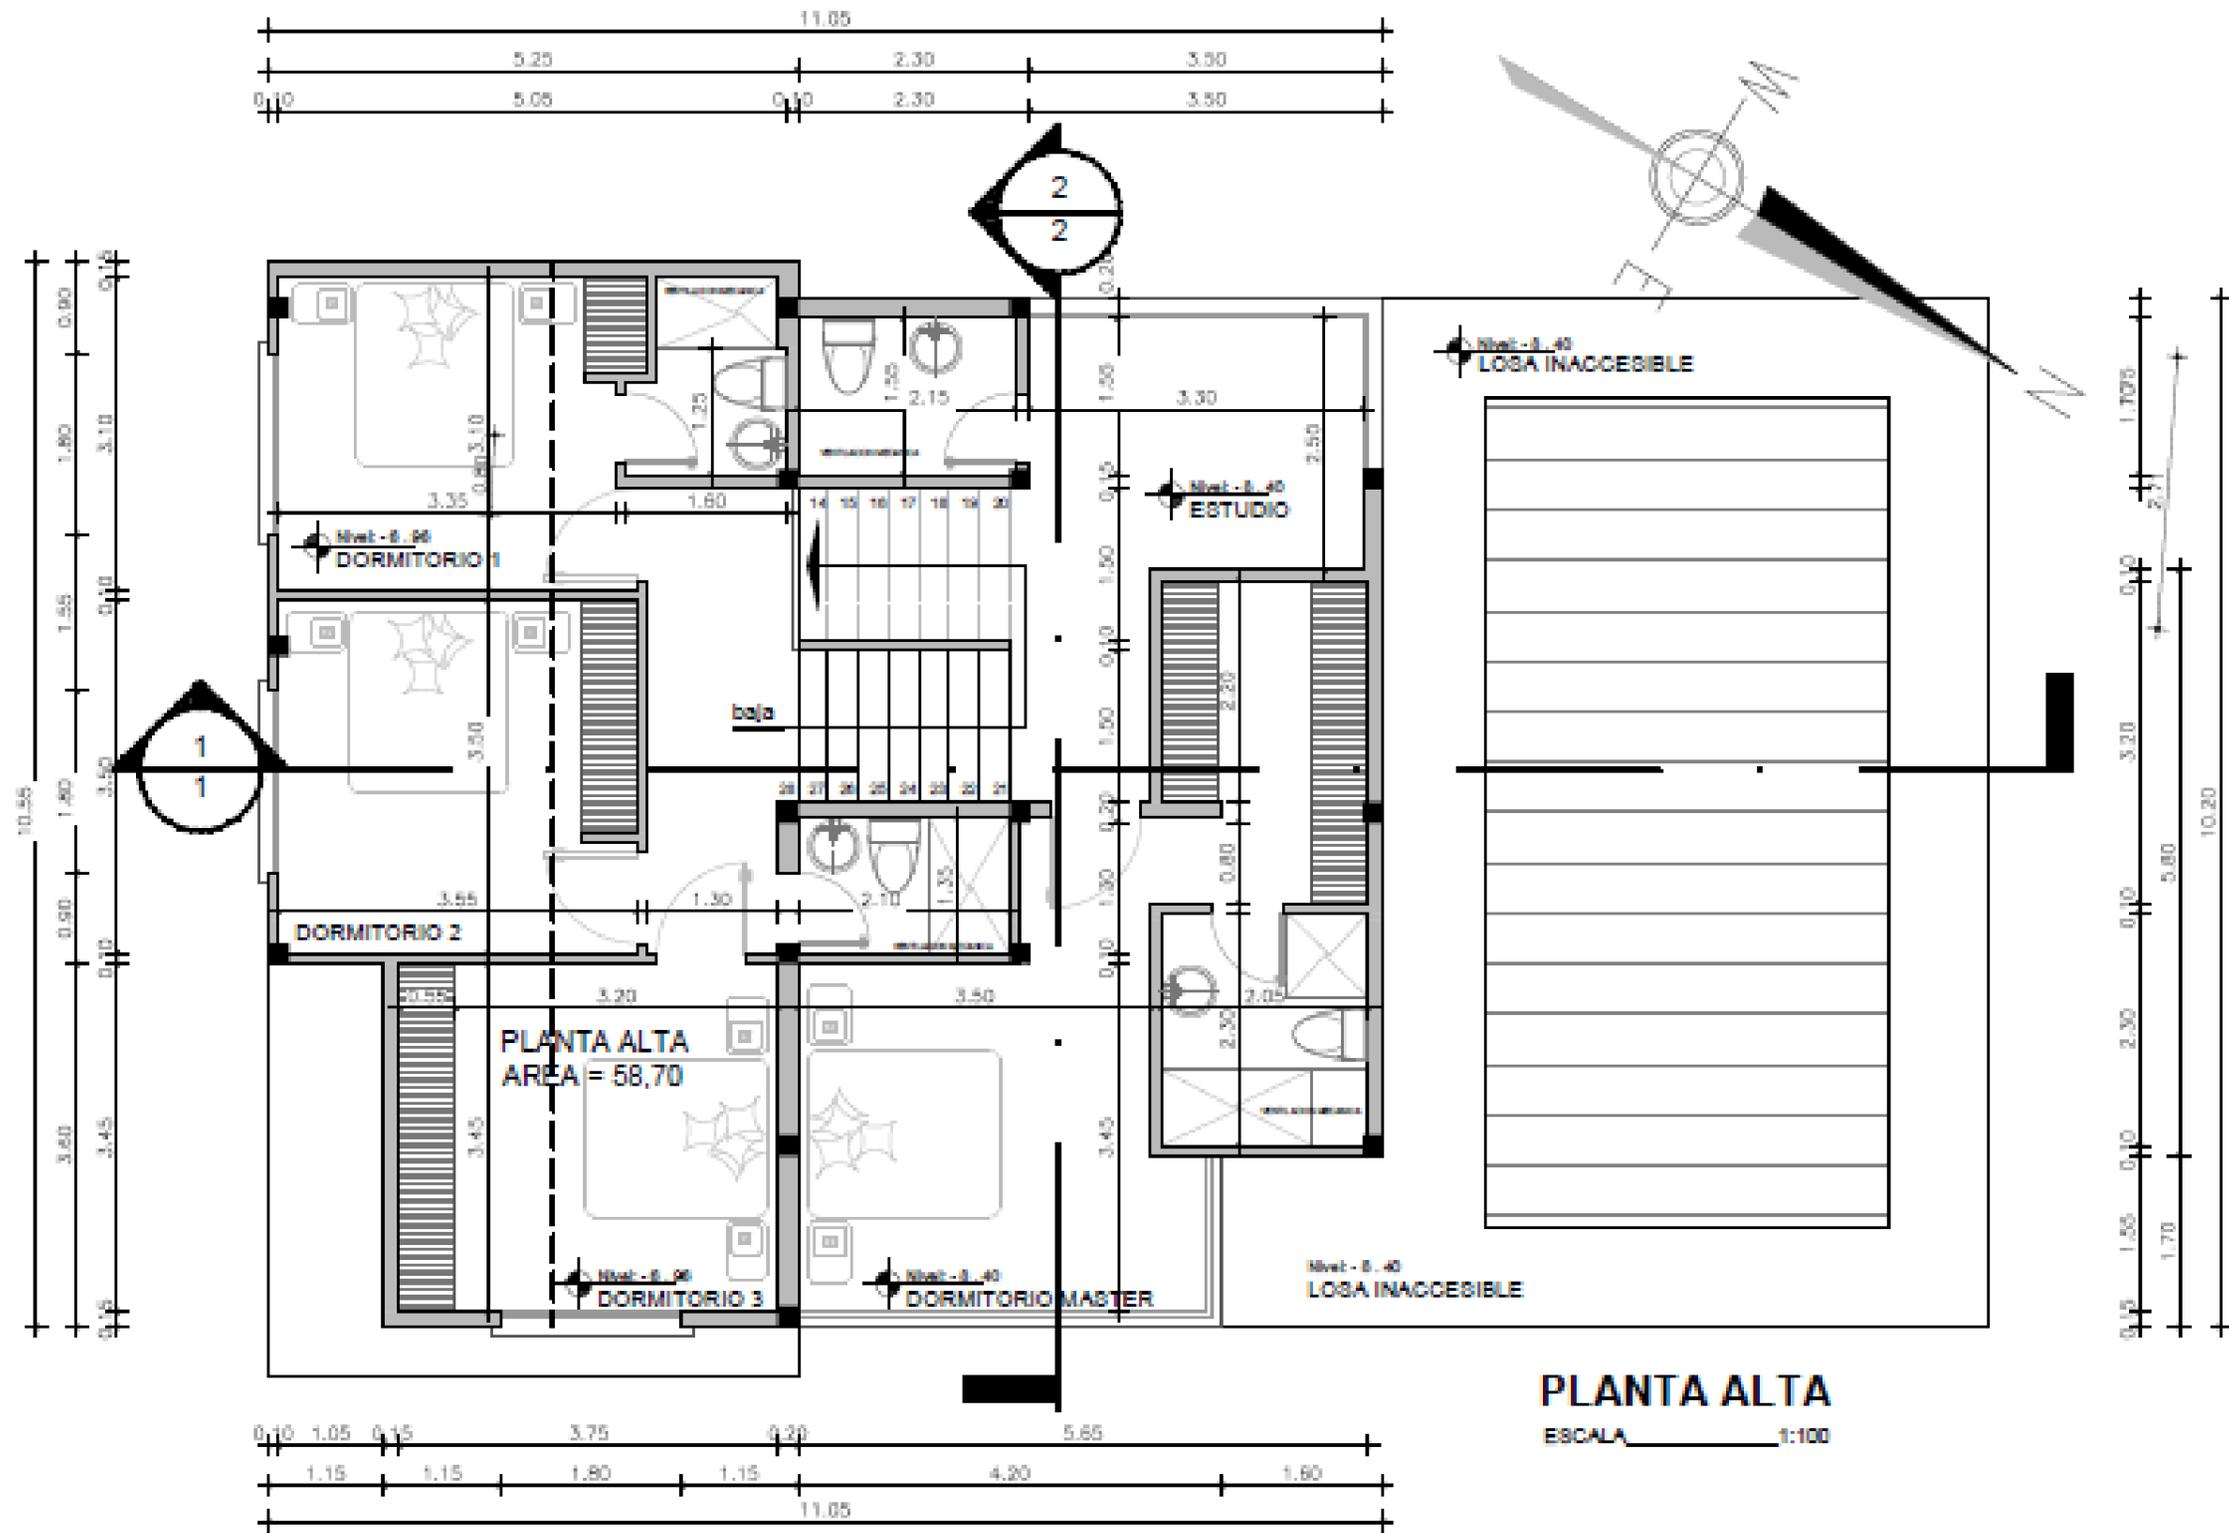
Planta Alta Casa 14 proyecto "El Peñón del Río"
